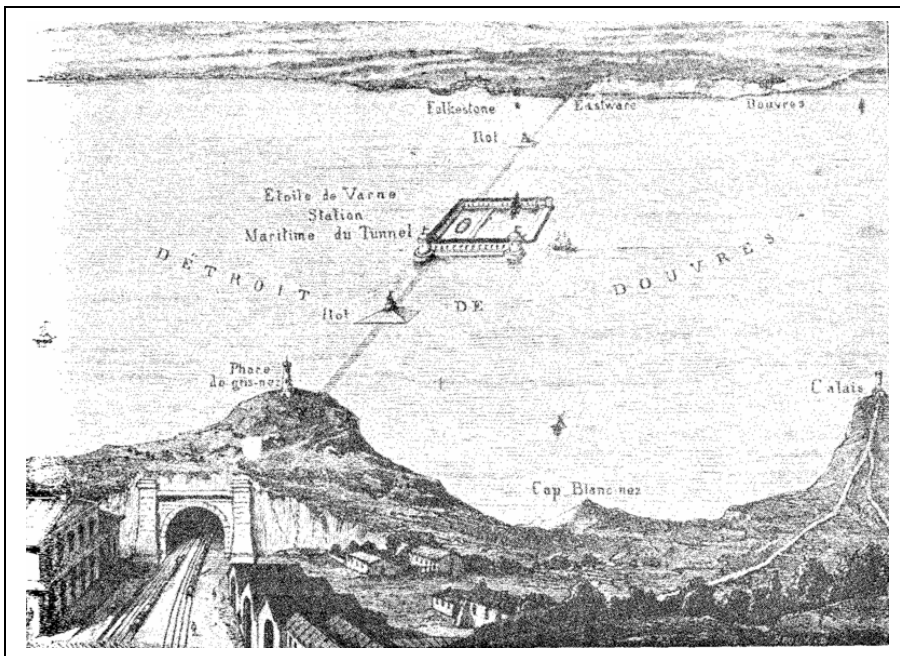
Thome de Gamond's Plan für einen Ärmelkanaltunnel aus dem Jahr 1856 (Scan aus Thomas Whitesides „The Tunnel under the Channel“, via wikipedia am 3.6.2010 heruntergeladen)
